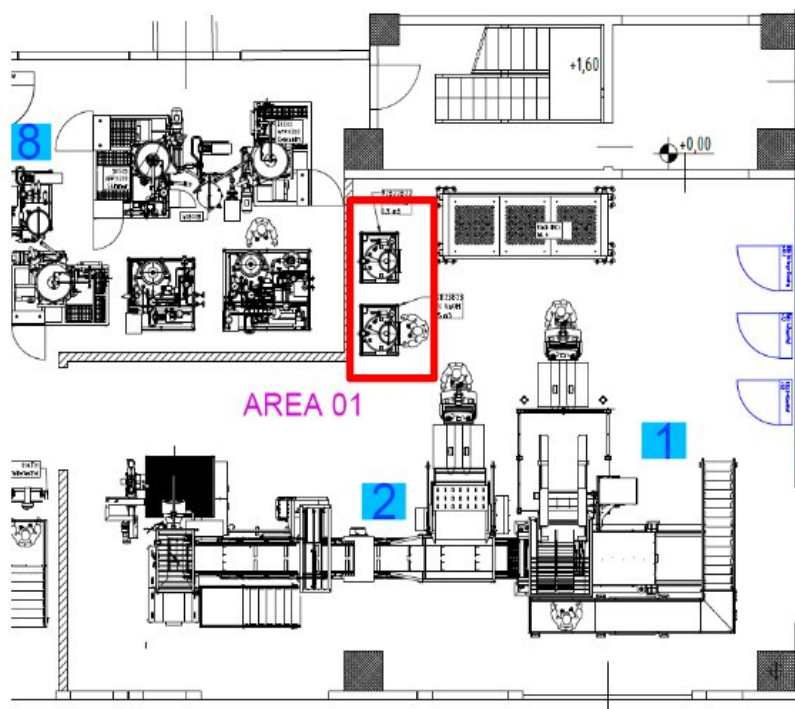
Stralcio planimetria piano terra revisionato - In rosso evidenziati i serbatoi da 0,5 mc nell'ubicazione aggiornata corretta
